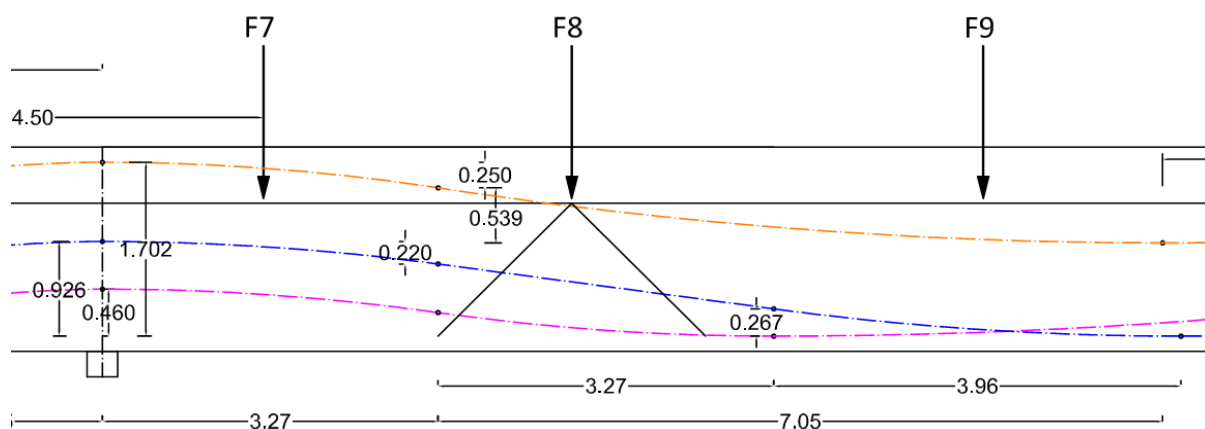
Traçados do pré-esforço à direita do apoio central da viga
